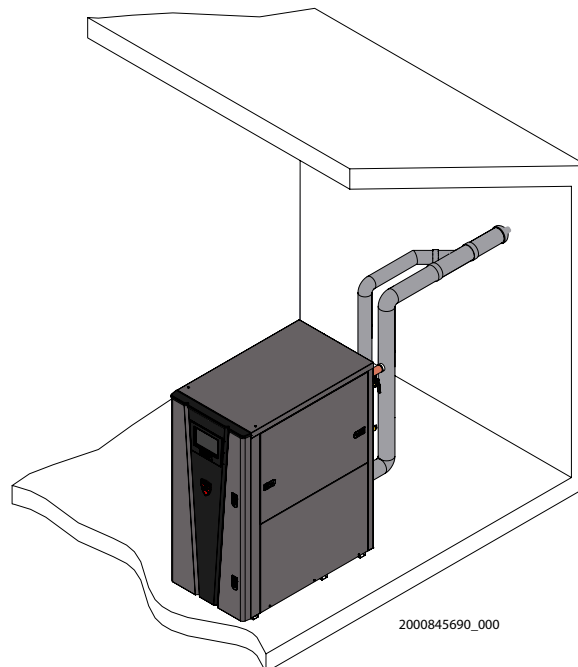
Terminaison murale concentrique en PVC/CPVC
